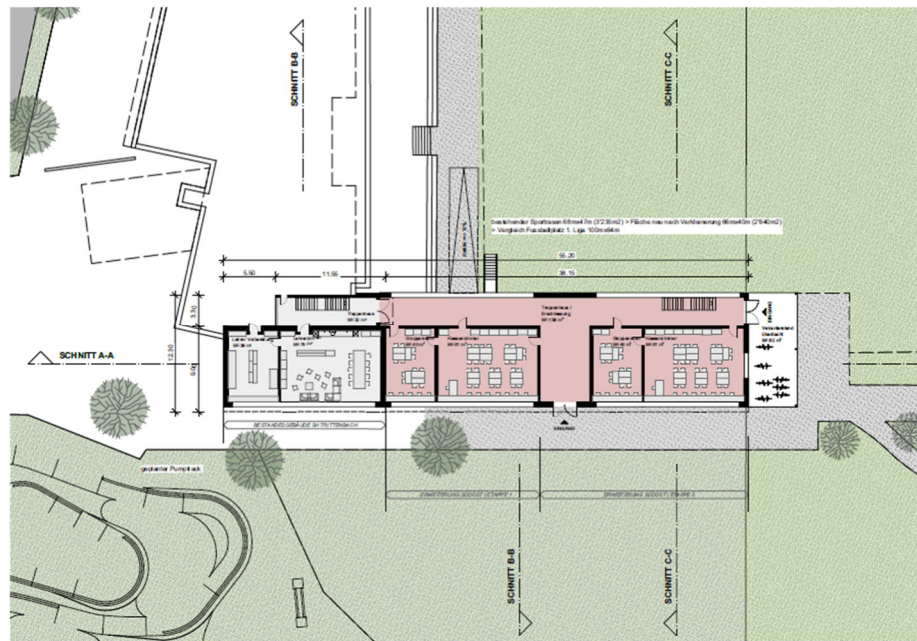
Disposition 01 | Grundriss Erdgeschoss
